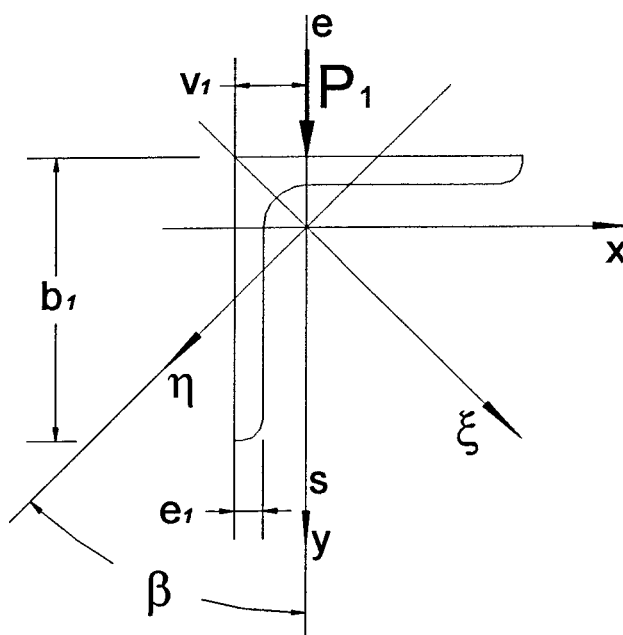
SECÇÃO TRANSVERSAL DA CANTONEIRA TIPO 1
